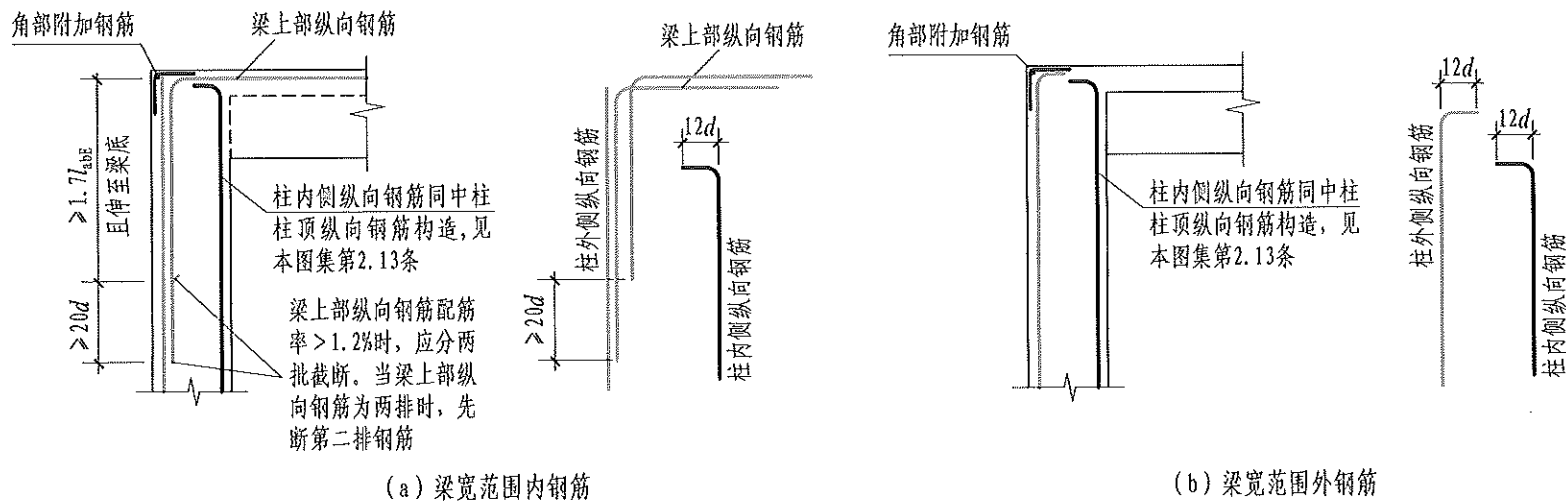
柱外侧纵向钢筋和梁上部钢筋在柱顶外侧直线搭接构造
